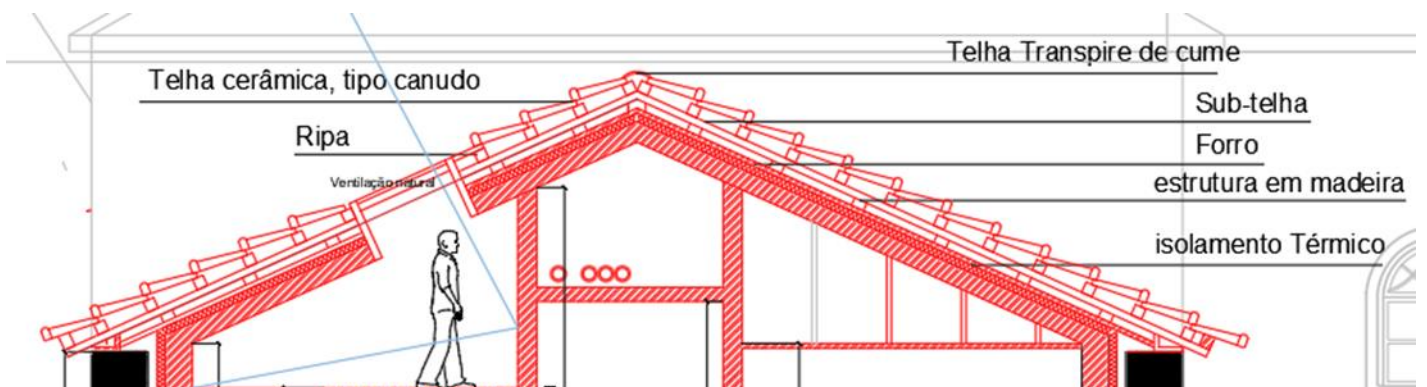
Corte pormenor de reabilitação da estrutura da cobertura do Paço
